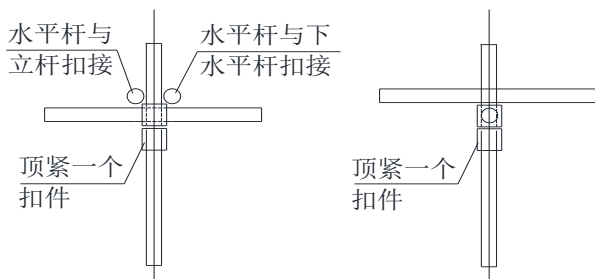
构造三节点（满堂脚手架施工层受力节点）简图
